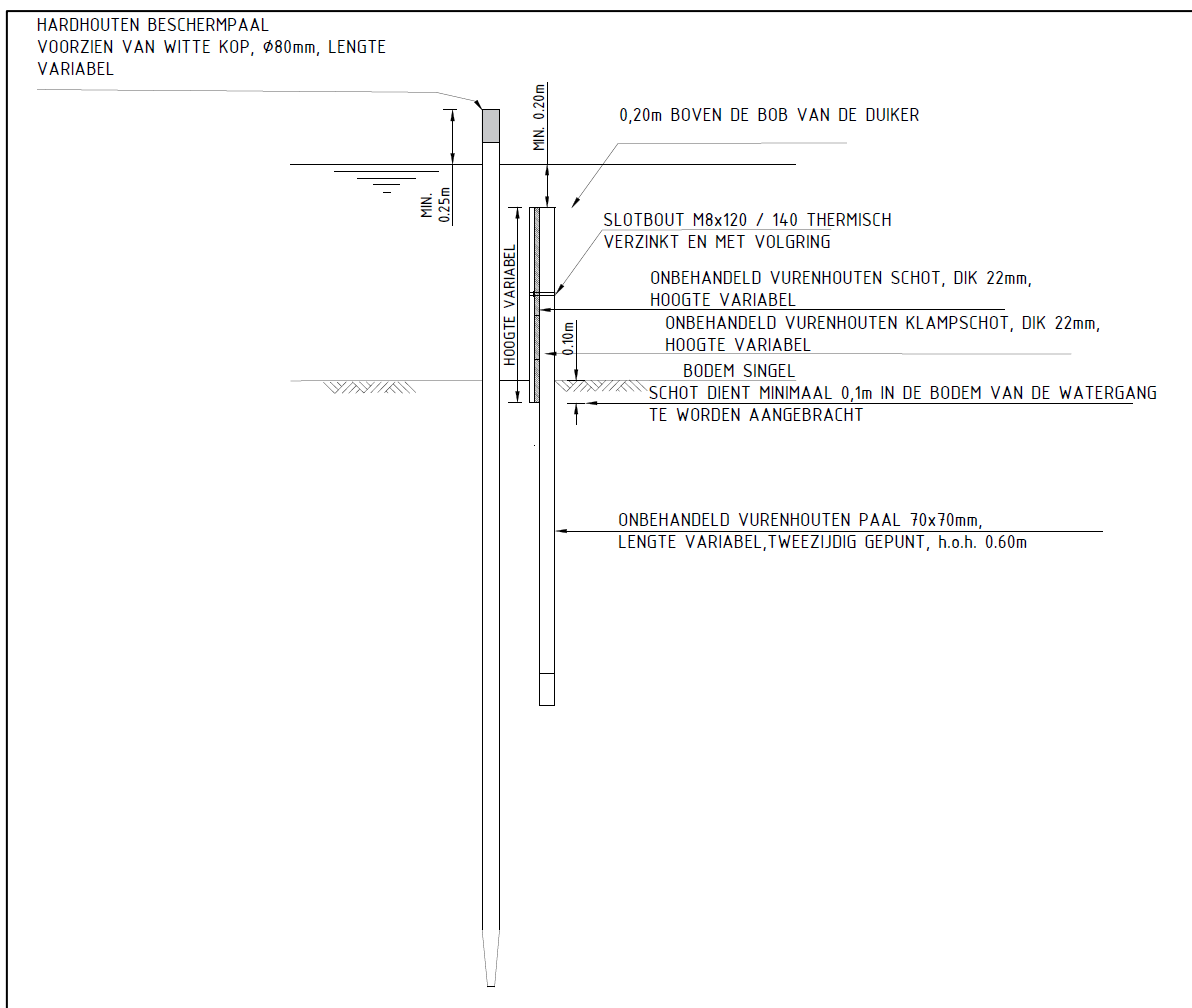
Principedetail bovenaanzicht duiker + baggerschot, haaks op de watergang
